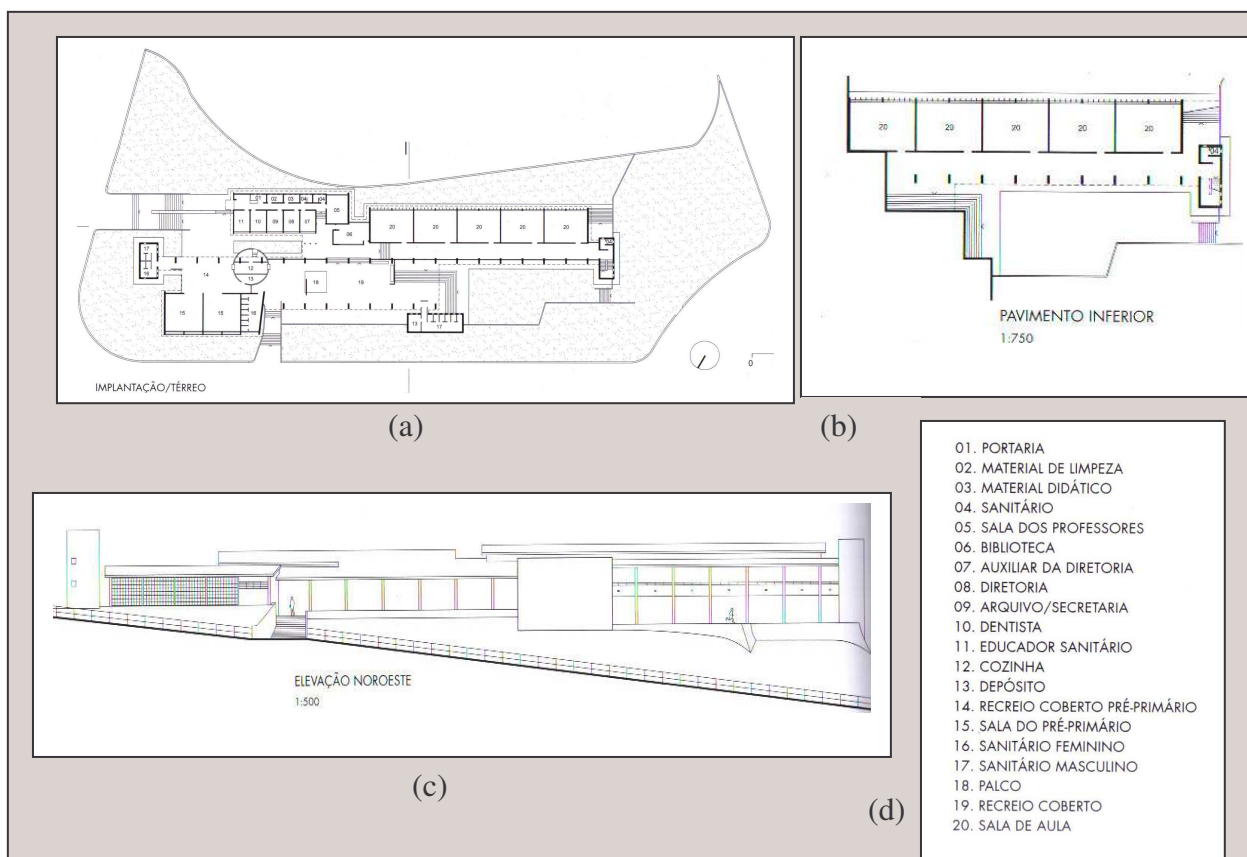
Escola Estadual Milton de Tolosa (1961), em Campinas, SP. (a): planta baixa da implantação e pavimento térreo; (b): planta baixa do pavimento inferior; (c): elevação ou fachada noroeste; (d) Legenda.
